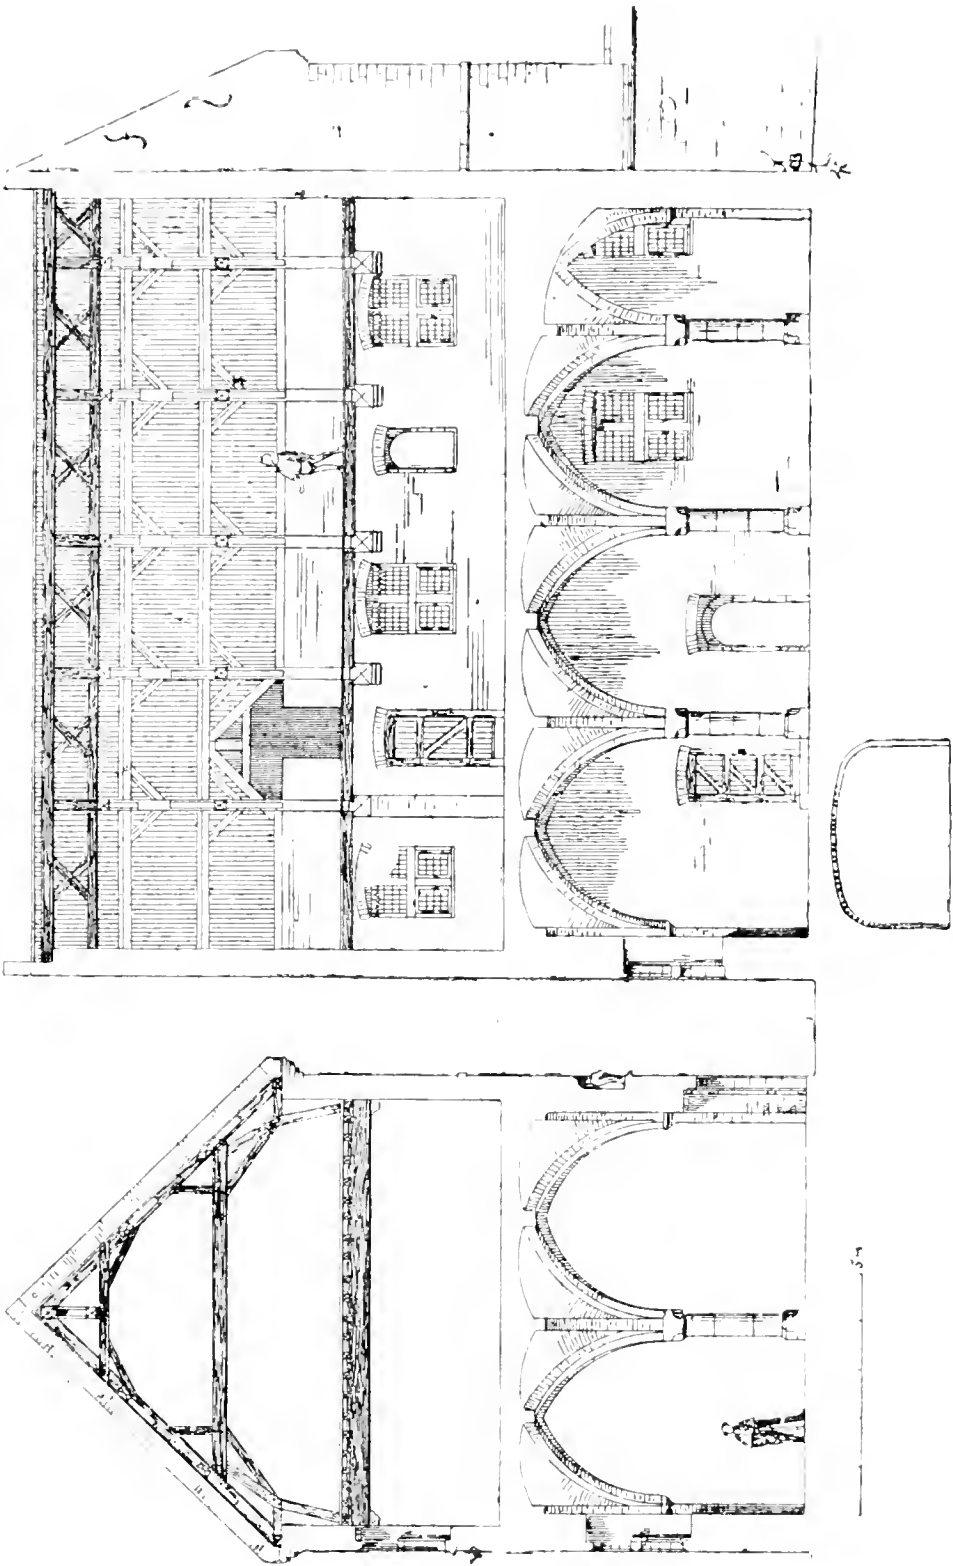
Coupes transversale et longitudinale de la Brasserie. Restauration.
